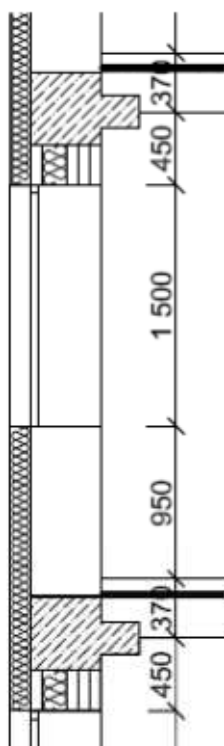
výřez - půdorys – zděná obvodová konstrukce
